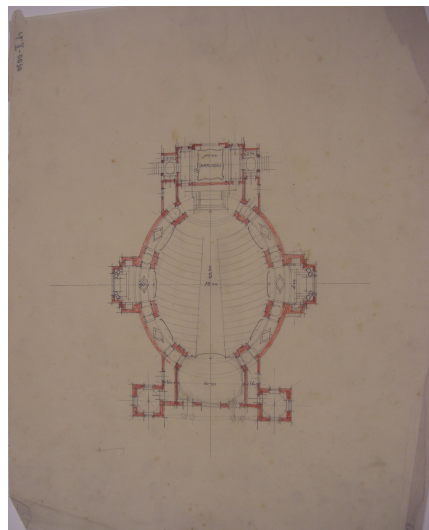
Grundriss Vorentwurf (Gruppe 1), Nr. 1
